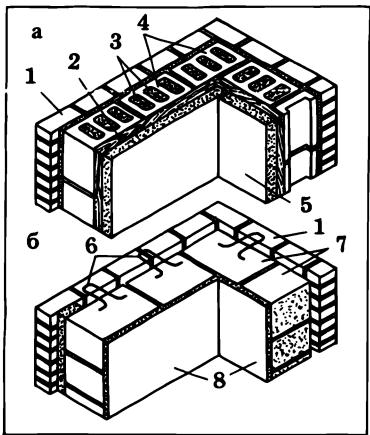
Варианты стен из легкобетонных блоков, облицованных кирпичом
